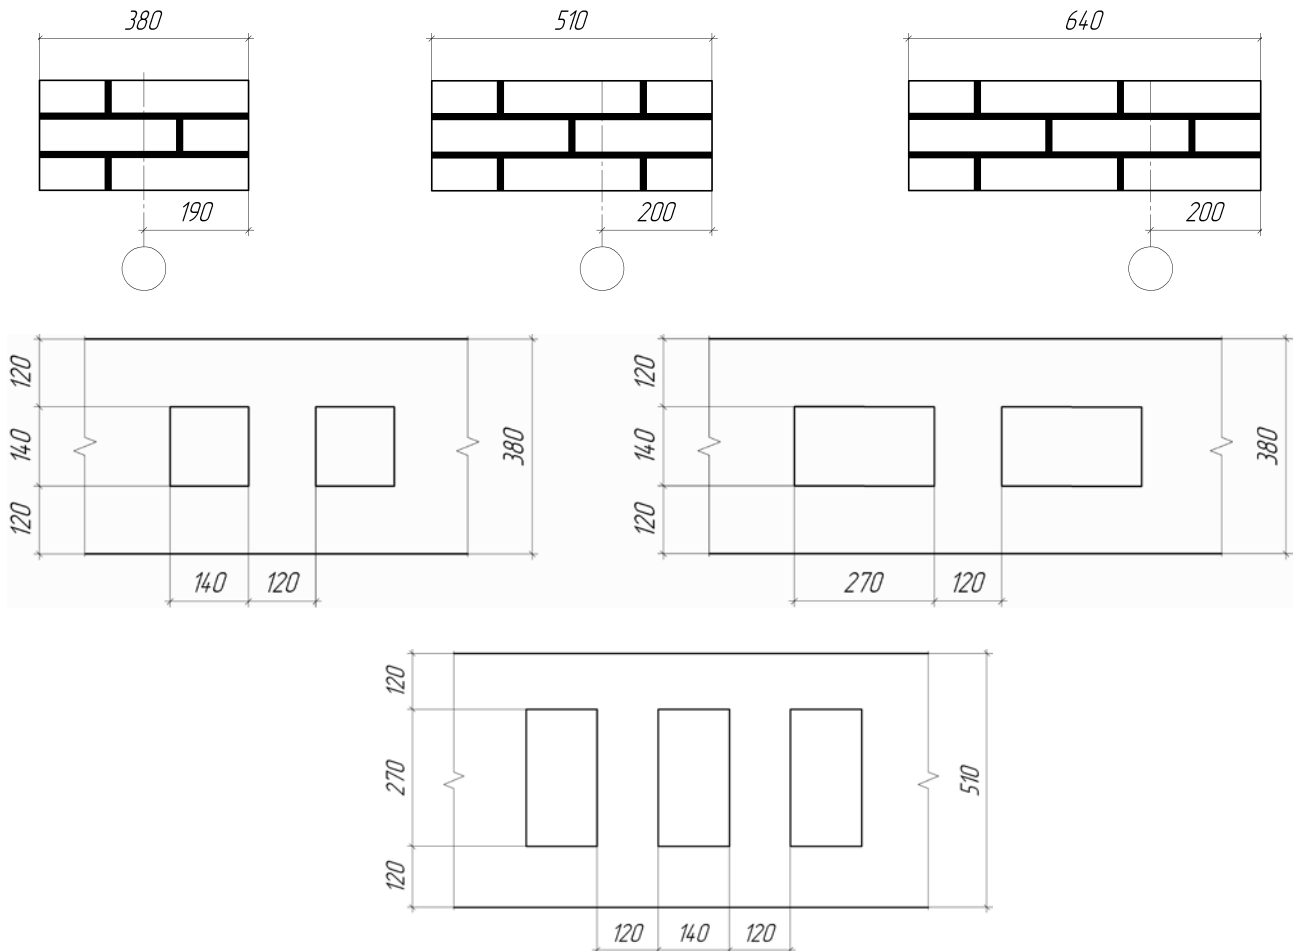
Ширина стены и размеры вентиляционных каналов во внутренних стенах
